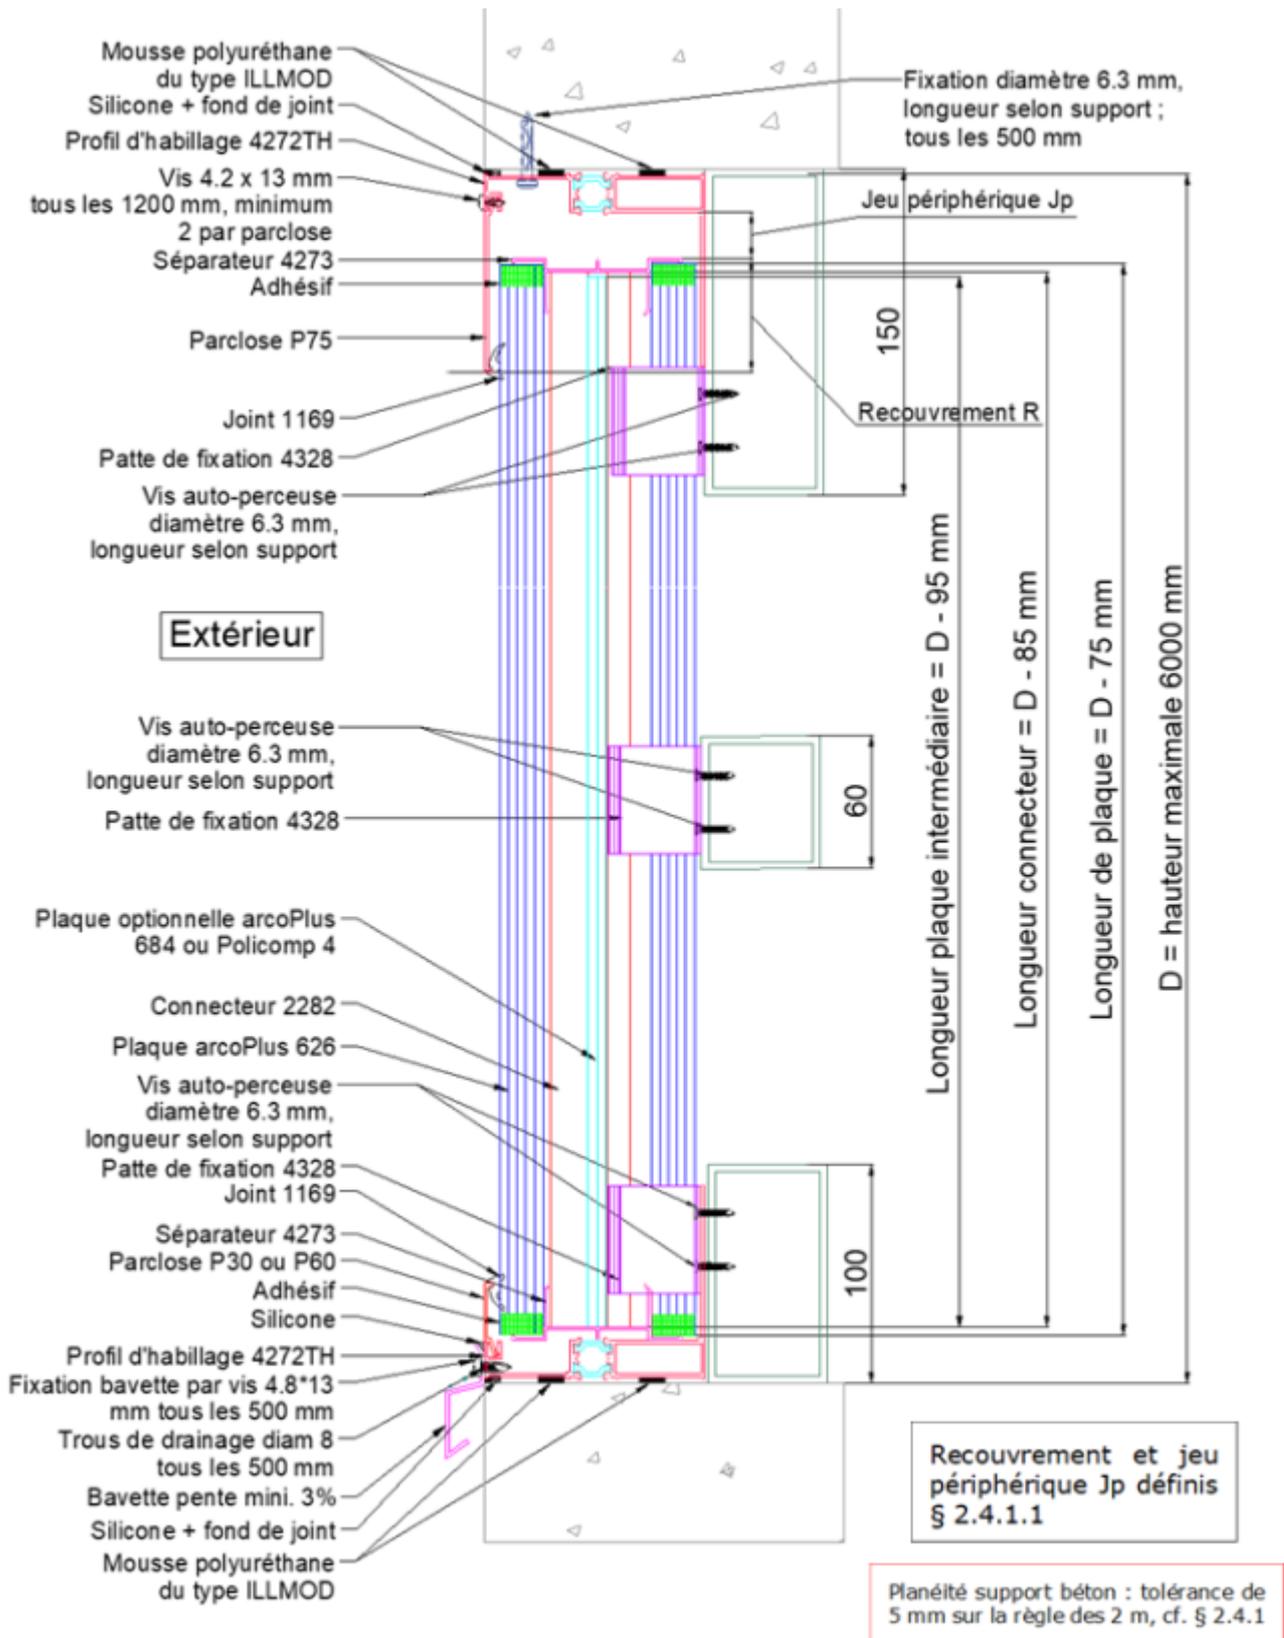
Pose en feuillure – Hauteurs de façade comprises entre 0 et 6 mètres
